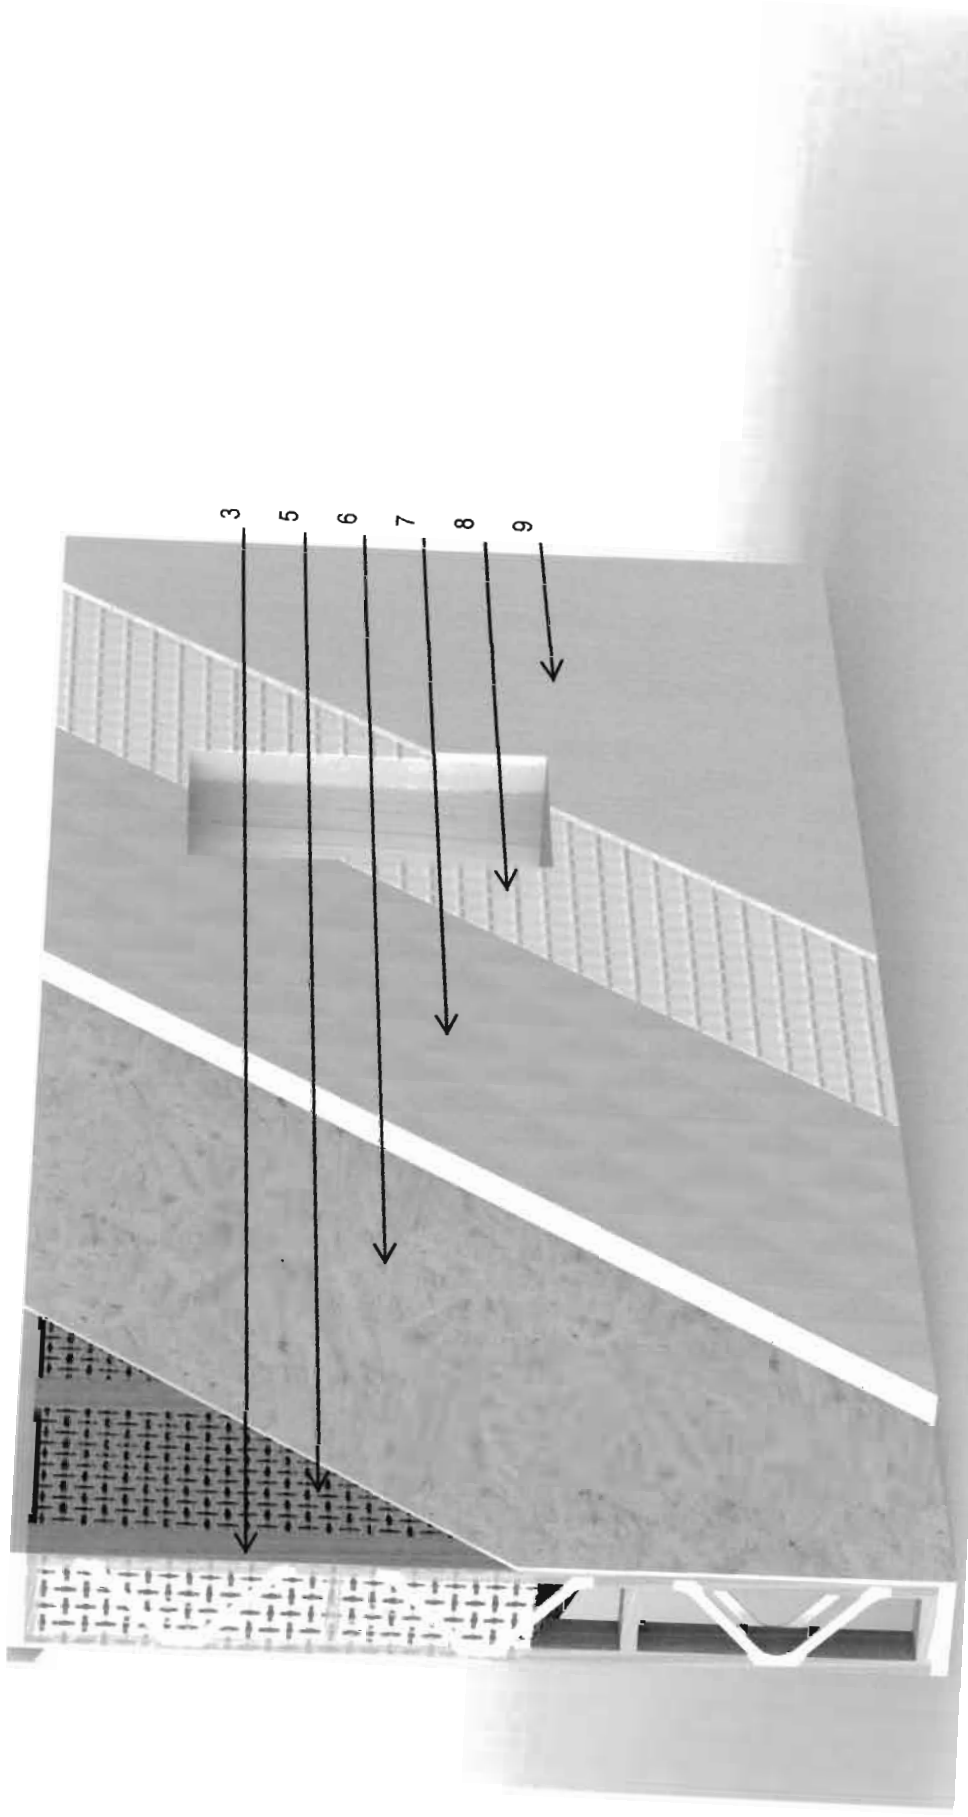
a STRUCTURĂ PERETE CAZE® 490mm
